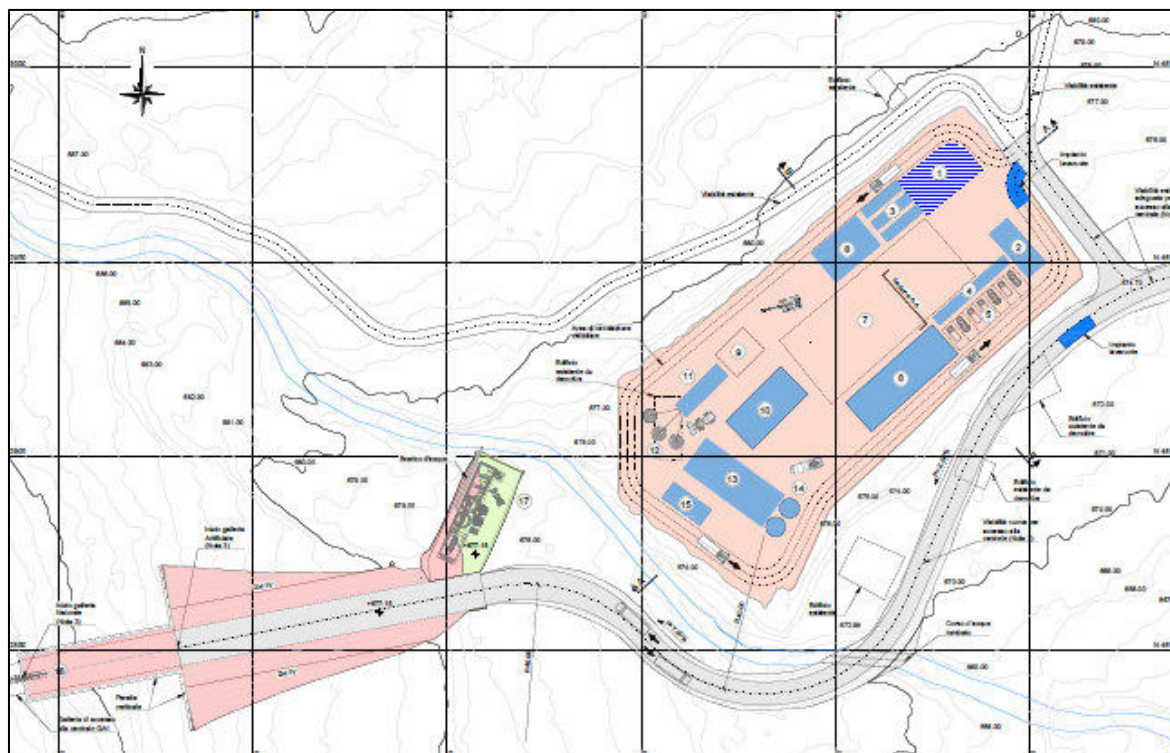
Ambito Pizzone - Area di cantiere CO.03 – Galleria di accesso alla centrale
